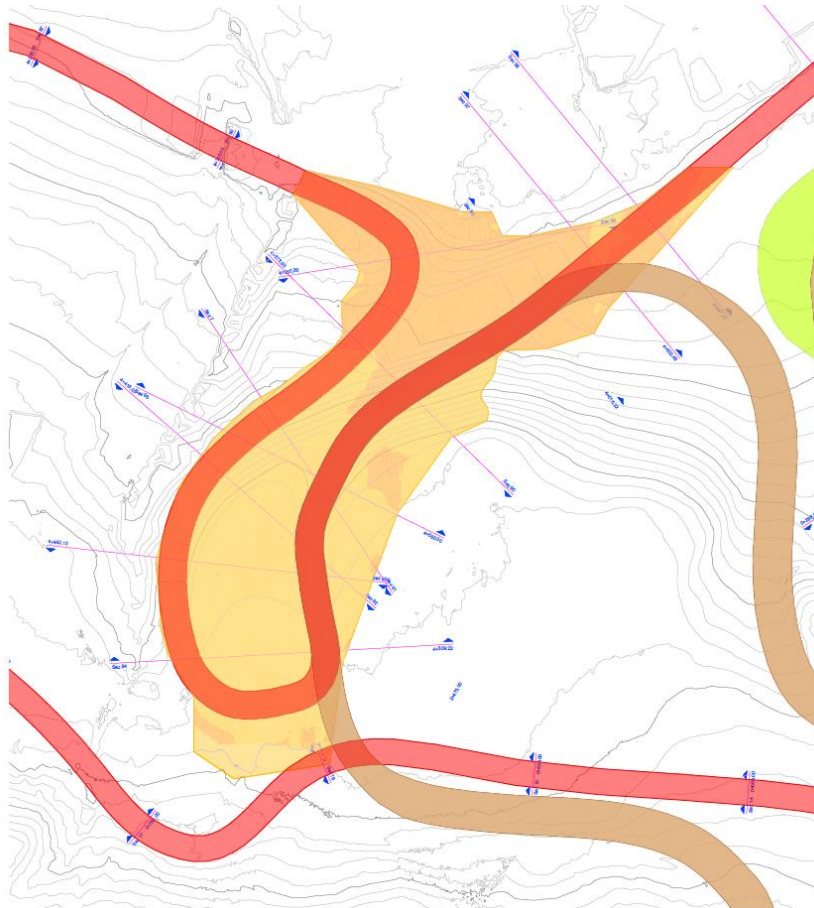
Estratto planimetria sterri e riporti - scala a vista
